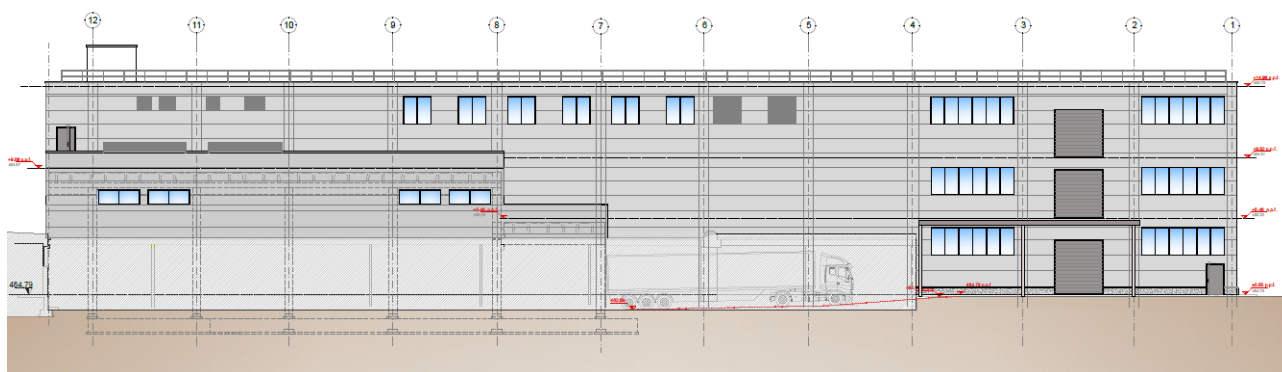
Prospetto Est - Fabbricato Ex. Piemonte
